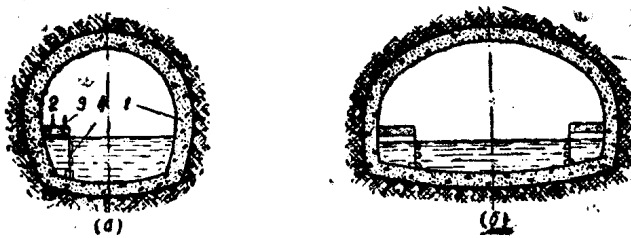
混凝土衬砌的单向(a)和双向(b)航运隧道截面图
